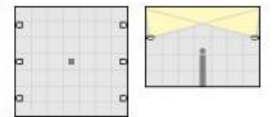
Techo plano. Recuperada de https://www.academia.edu/5516868/Es_erco_guide_3_indoor_lighting
